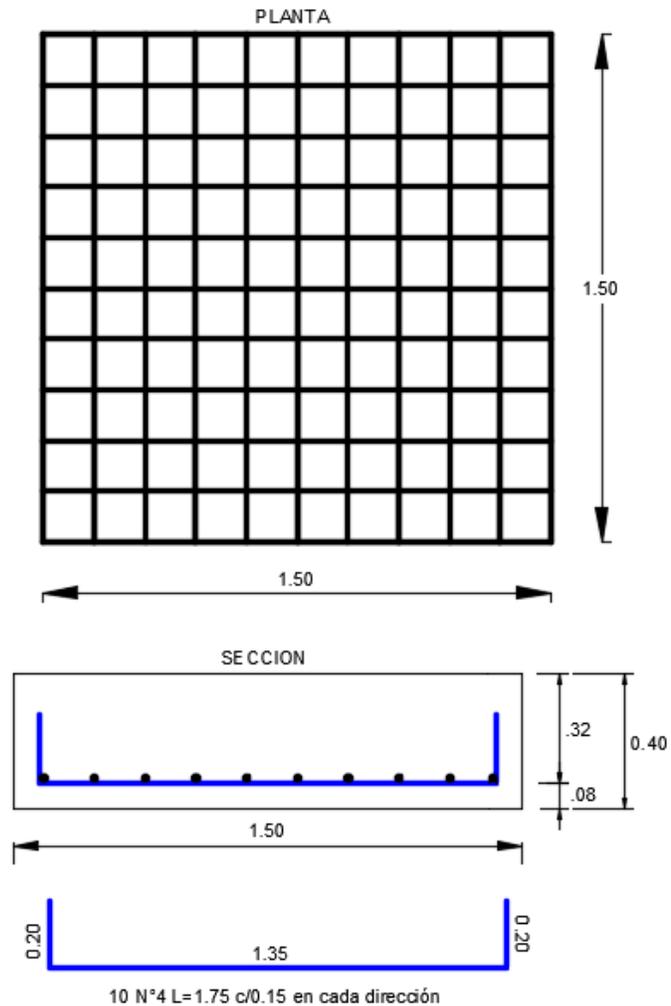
Detalles vista en planta Dados zapatas). Fuente: Diseños UT CONSULVIALES
